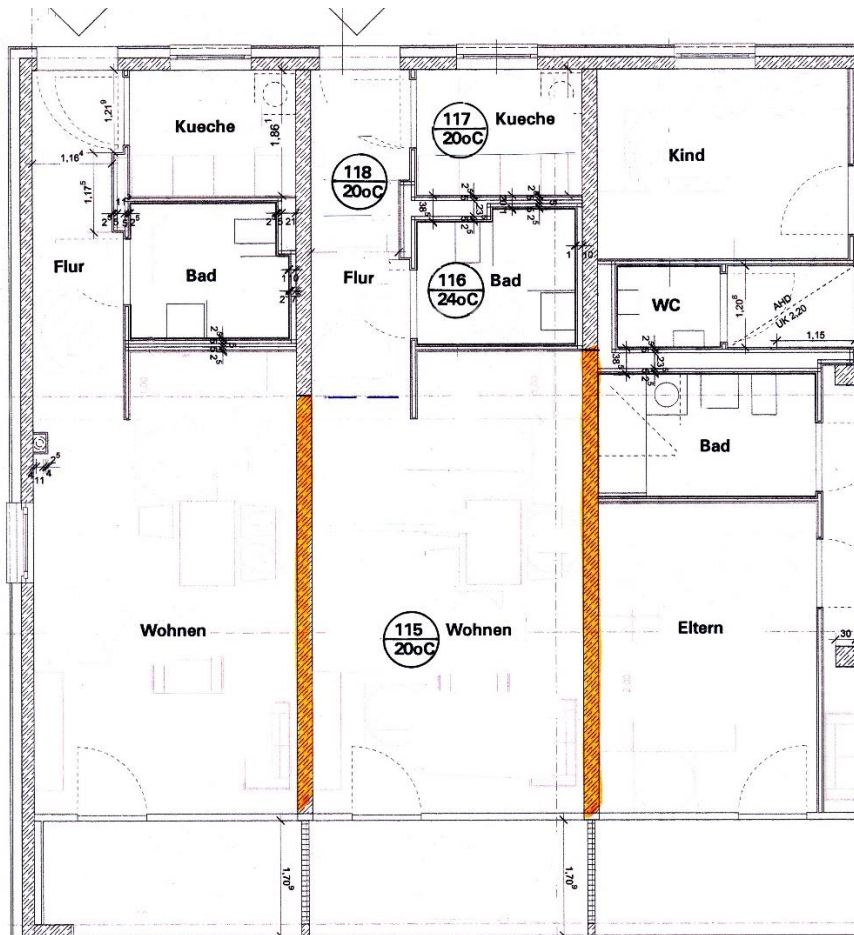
mit Wohnungstrennwänden (orange) zur eingeschränkt beheizten Nebenwohnung.
